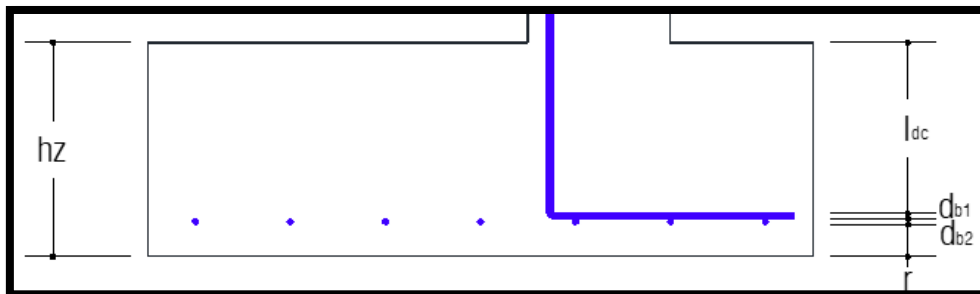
Predimensionamiento de la zapata (Elaboración propia)
